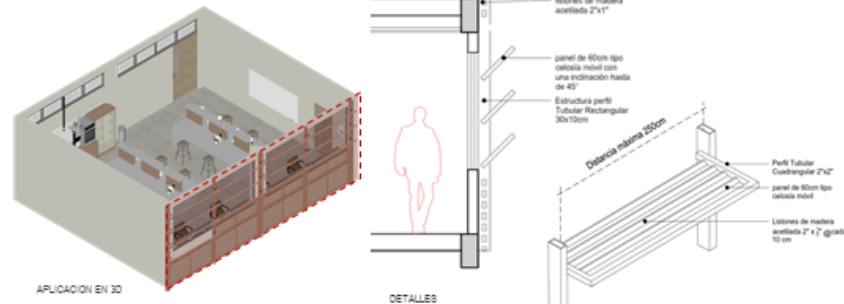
Vista 3d, detalles de elementos de protección aplicados en el laboratorio seleccionado.
